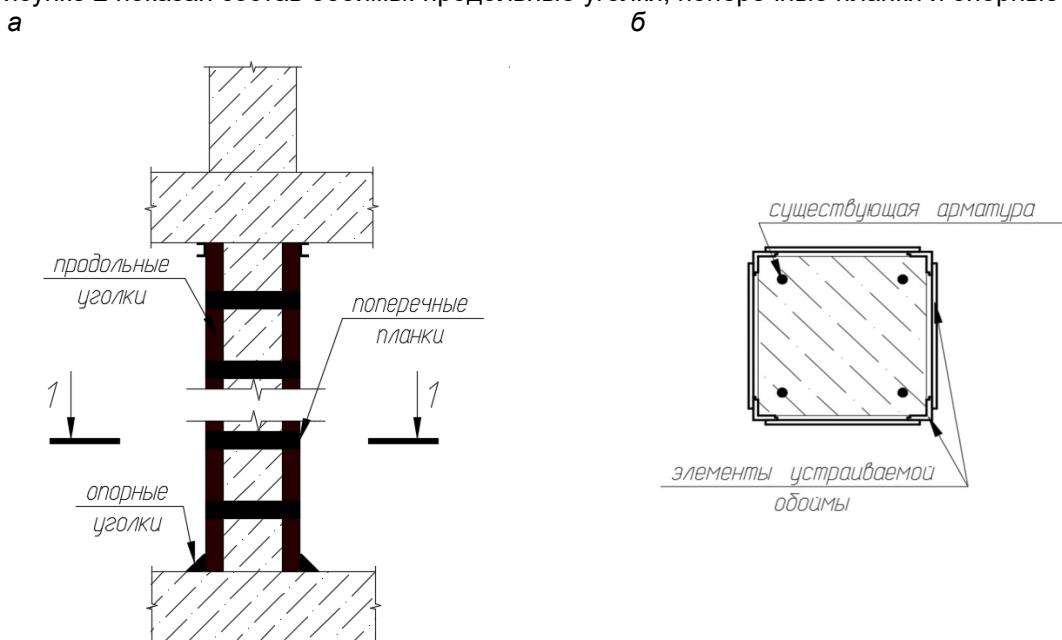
Усиление колонны стальной обоймой: а – общий вид; б – поперечный разрез
